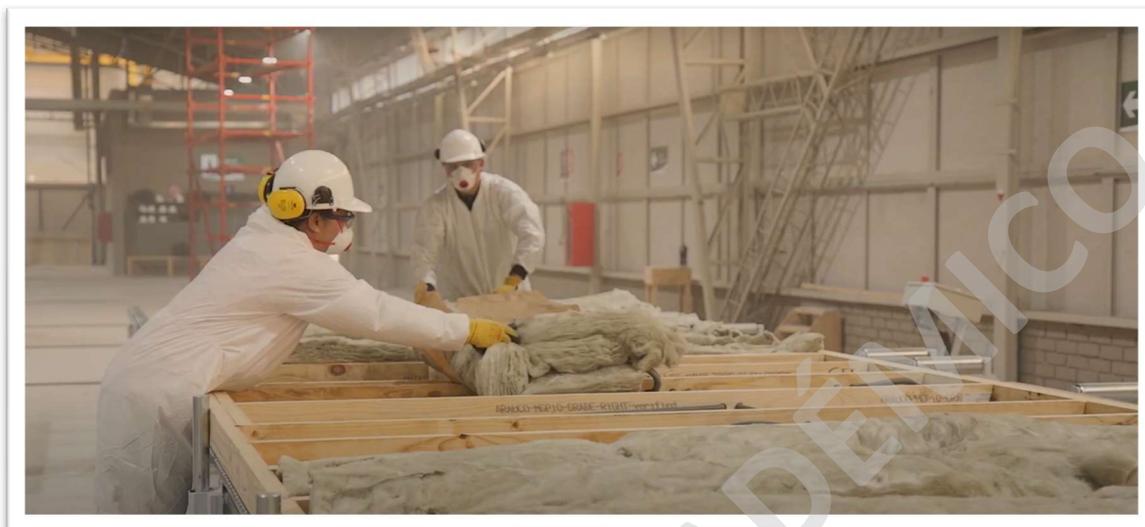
Colocación de Aislaciones en Muro en fabricación de vivienda social, Modulo Panelizado.
